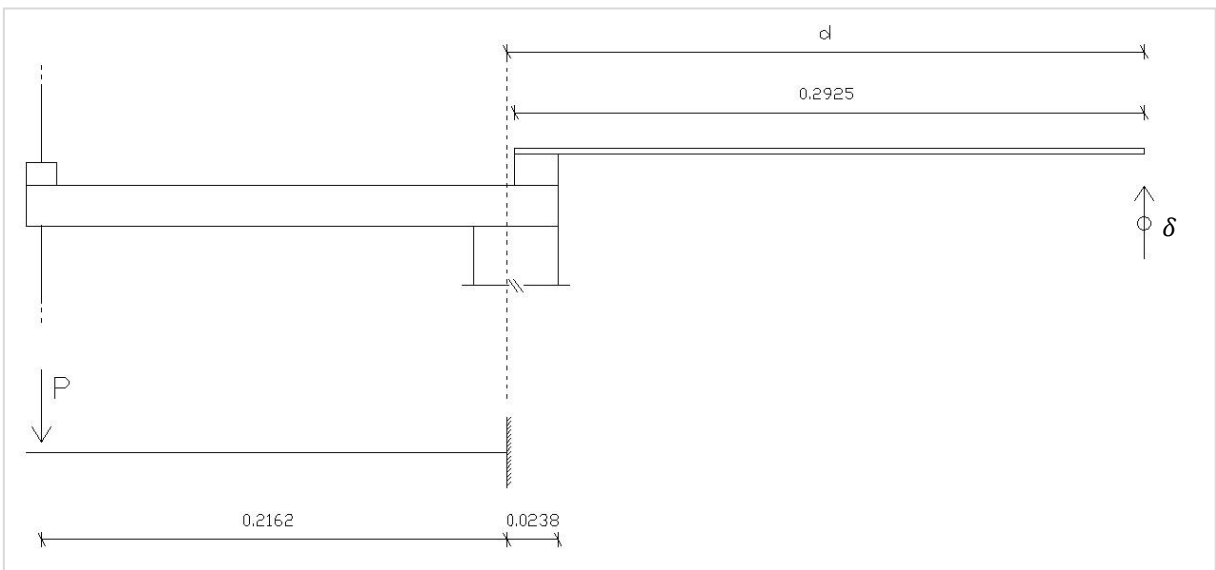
Esquema geral do provete submetido ao ensaio e esquema estrutural (dimensões em metros).
